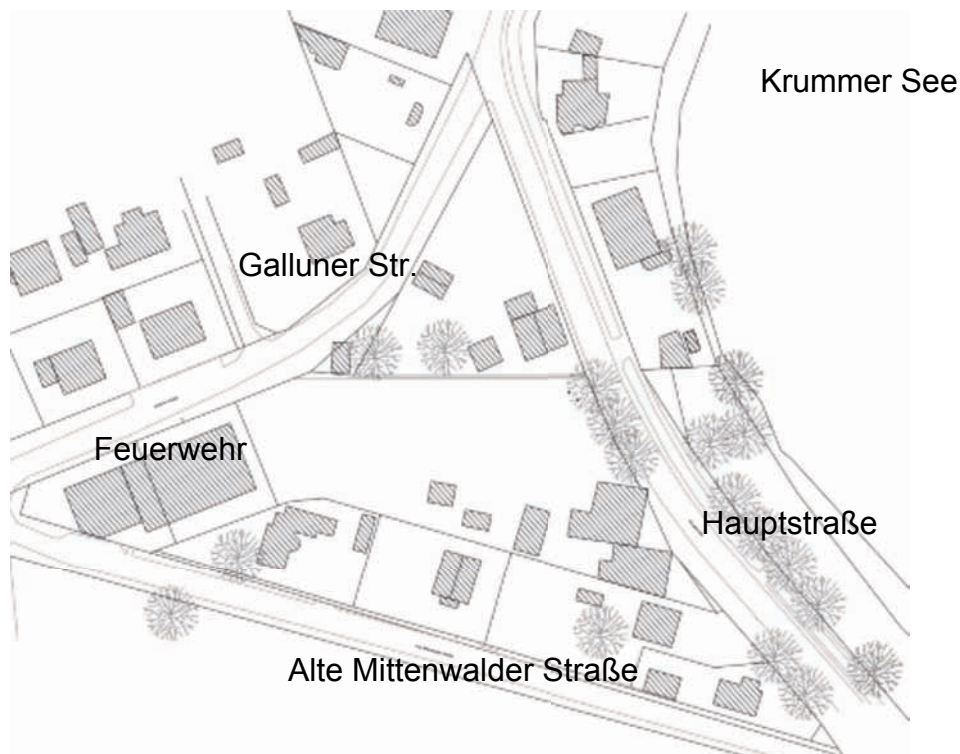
Lageplan mit Darstellung des westlich angrenzenden, großzügig erweiterten Feuerwehrgebäudes
